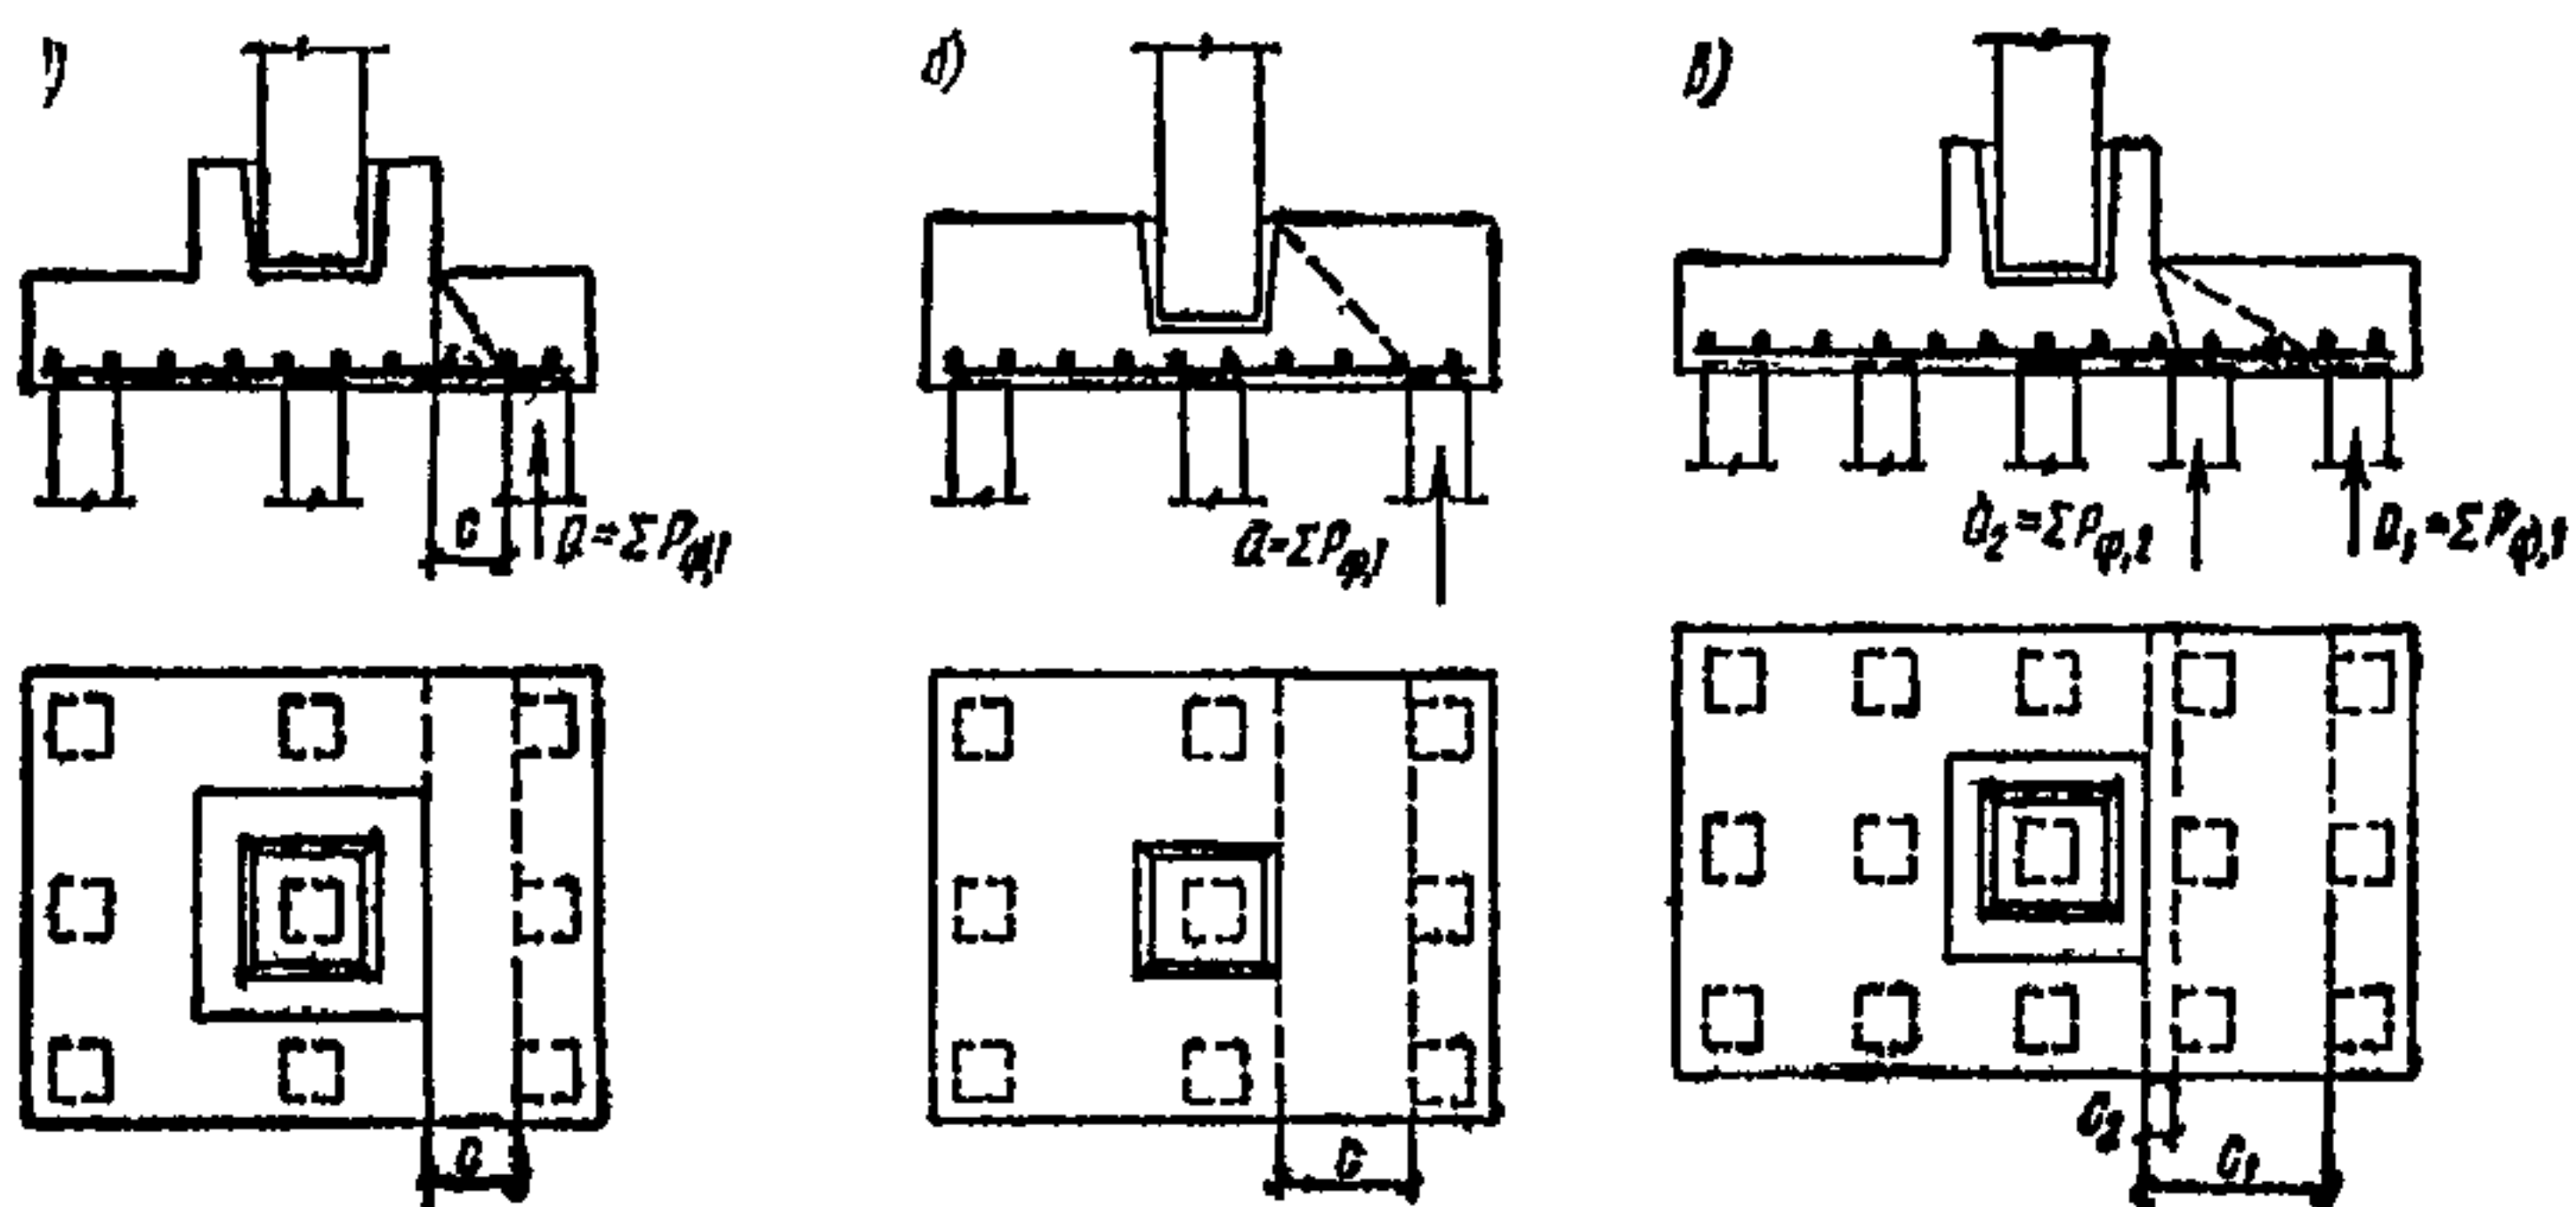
Схемы, принимаемые при расчете прочности наклонных сечений ростверка по поперечной силе
